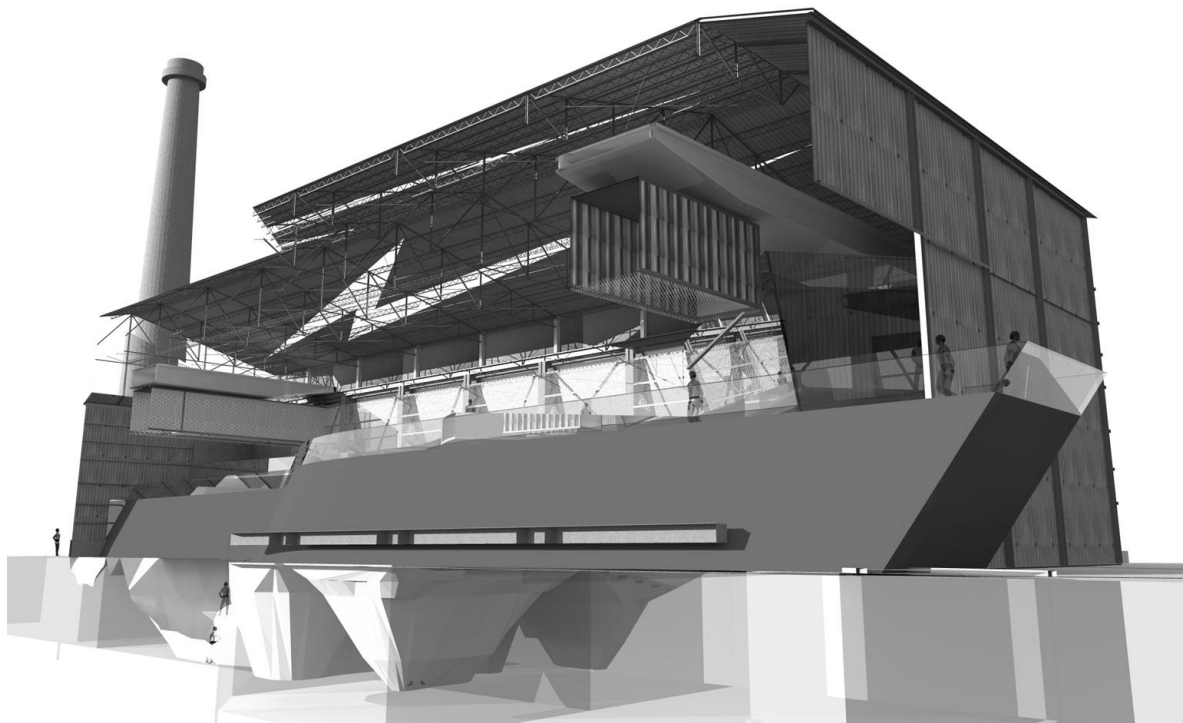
El edificio “A”, dentro de la fachada principal del conjunto.
